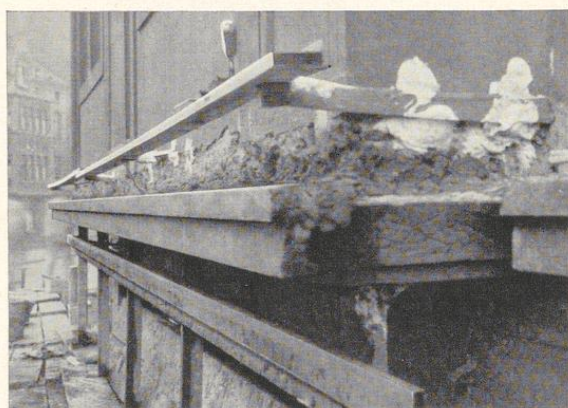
Der Anschlag für ein Gurtgesims an der Fassade
